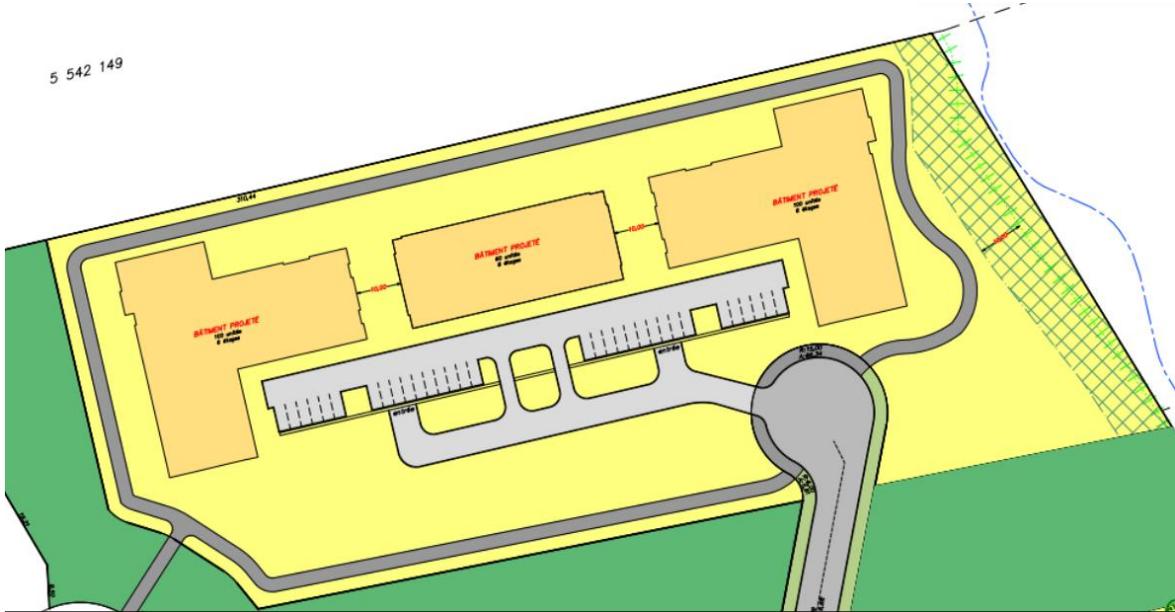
Plan d'aménagement d'ensemble des zones R-12 et CONS-6.
